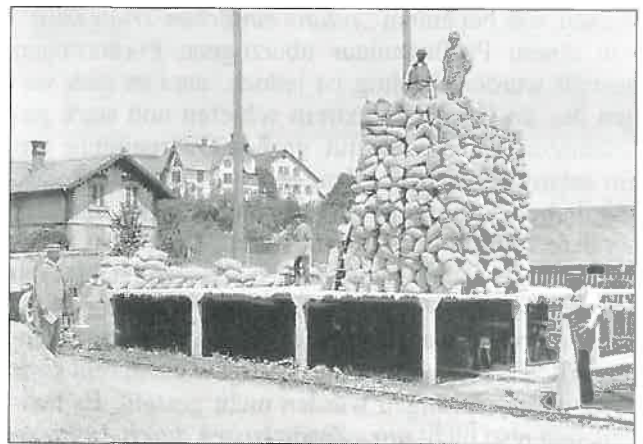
Belastungsversuche an Flachdecken von Robert Maillart, 1908 [1]
